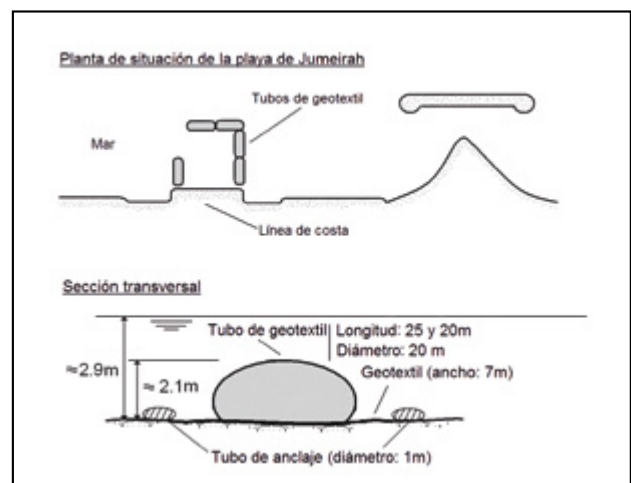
Planta y sección transversal de la costa de Jumeirah (Dubai).
